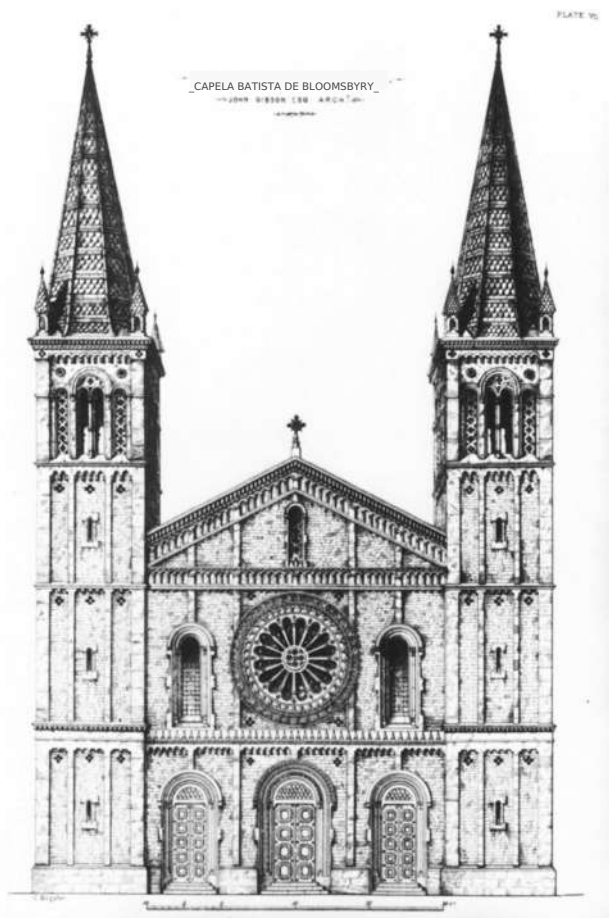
John Gibson, Bloomsbury Baptist Church, London, 1848, front elevation (Engenheiro Civil e *Architect's* Journal, 1848, Pl. 7).
